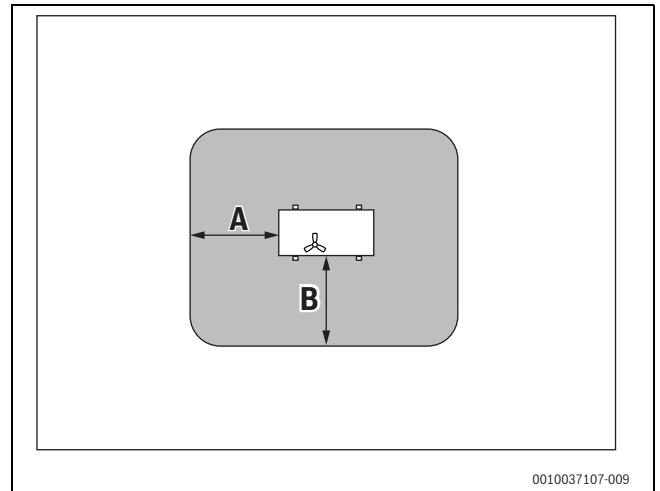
Schutzbereich bei bodenstehender Aufstellung auf dem Grundstück oder Dach
